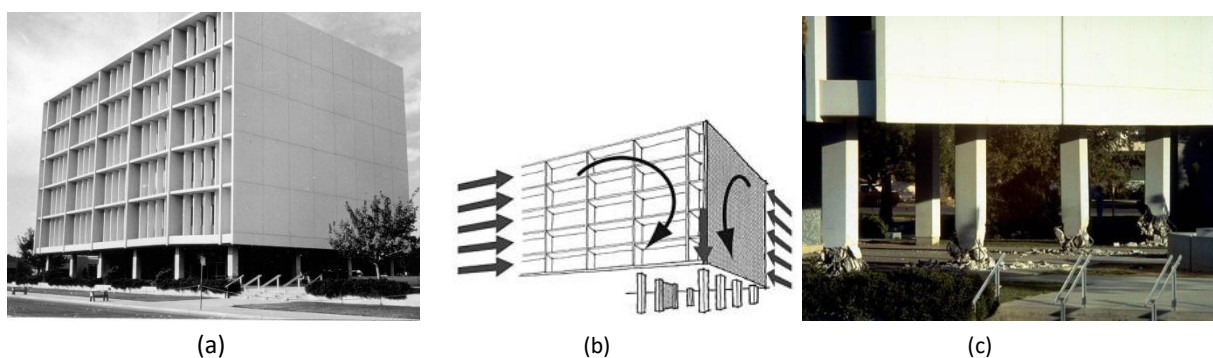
(a) Edifício Imperial County Services; (b) Forças geradas pela irregular configuração estrutural, sobrecarregando os pilares de canto do edifício (Fonte: [7]); (c) Danos nos pilares de canto do edifício.
